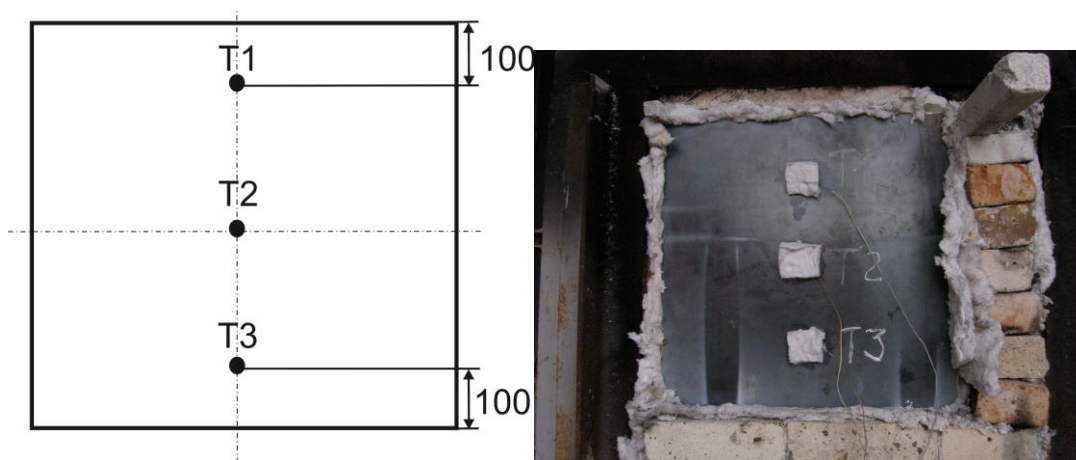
Схема розміщення термопар з необігрівної поверхні сталеві пластини.
